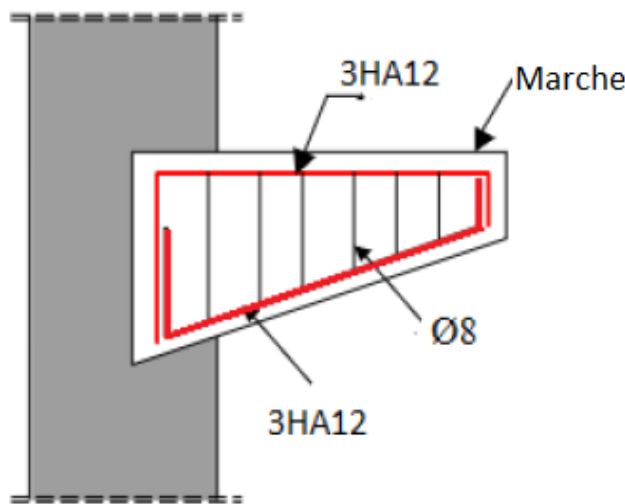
Schémas de ferrailage de l’escalier hélicoïdal
